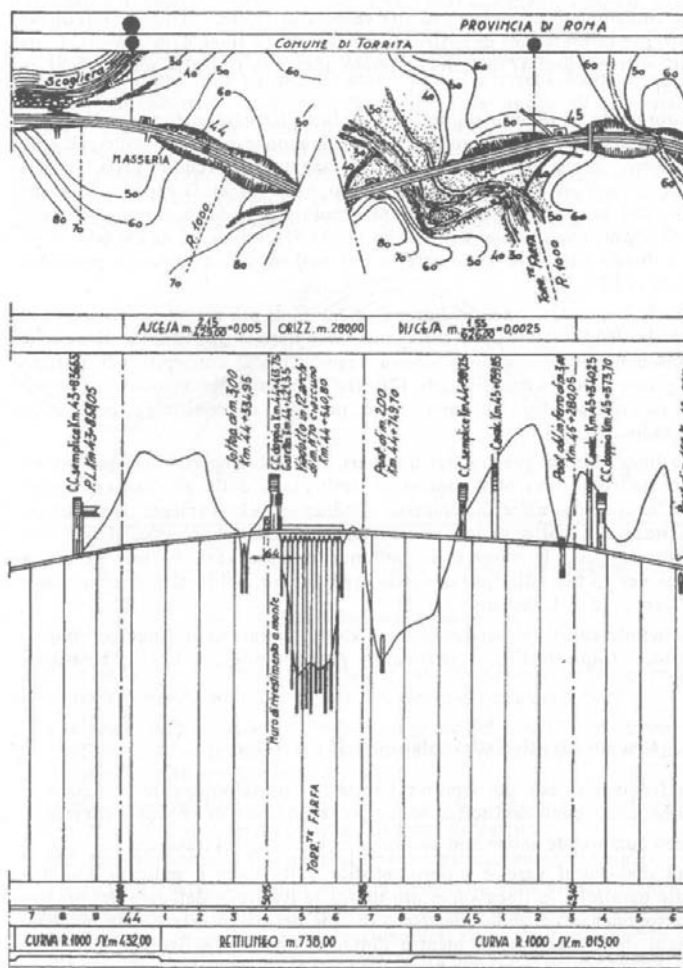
Planimetria–profilo longitudinale di una linea ferroviaria
